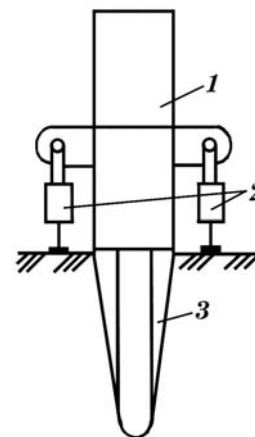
Установка для образования скважин: 1 – сваебойный агрегат со штанговым дизель-молотом; 2 – гидроцилиндры, 3 – штамп.
